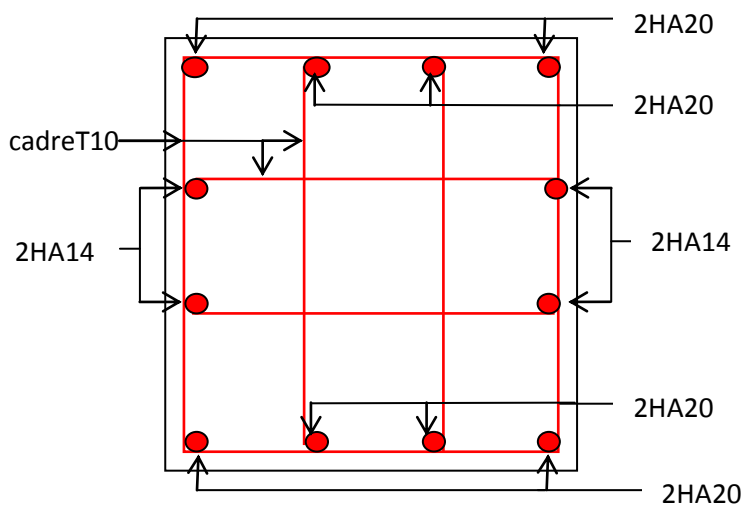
Ferrailage poteau 2^{ème}, 3^{ème}
